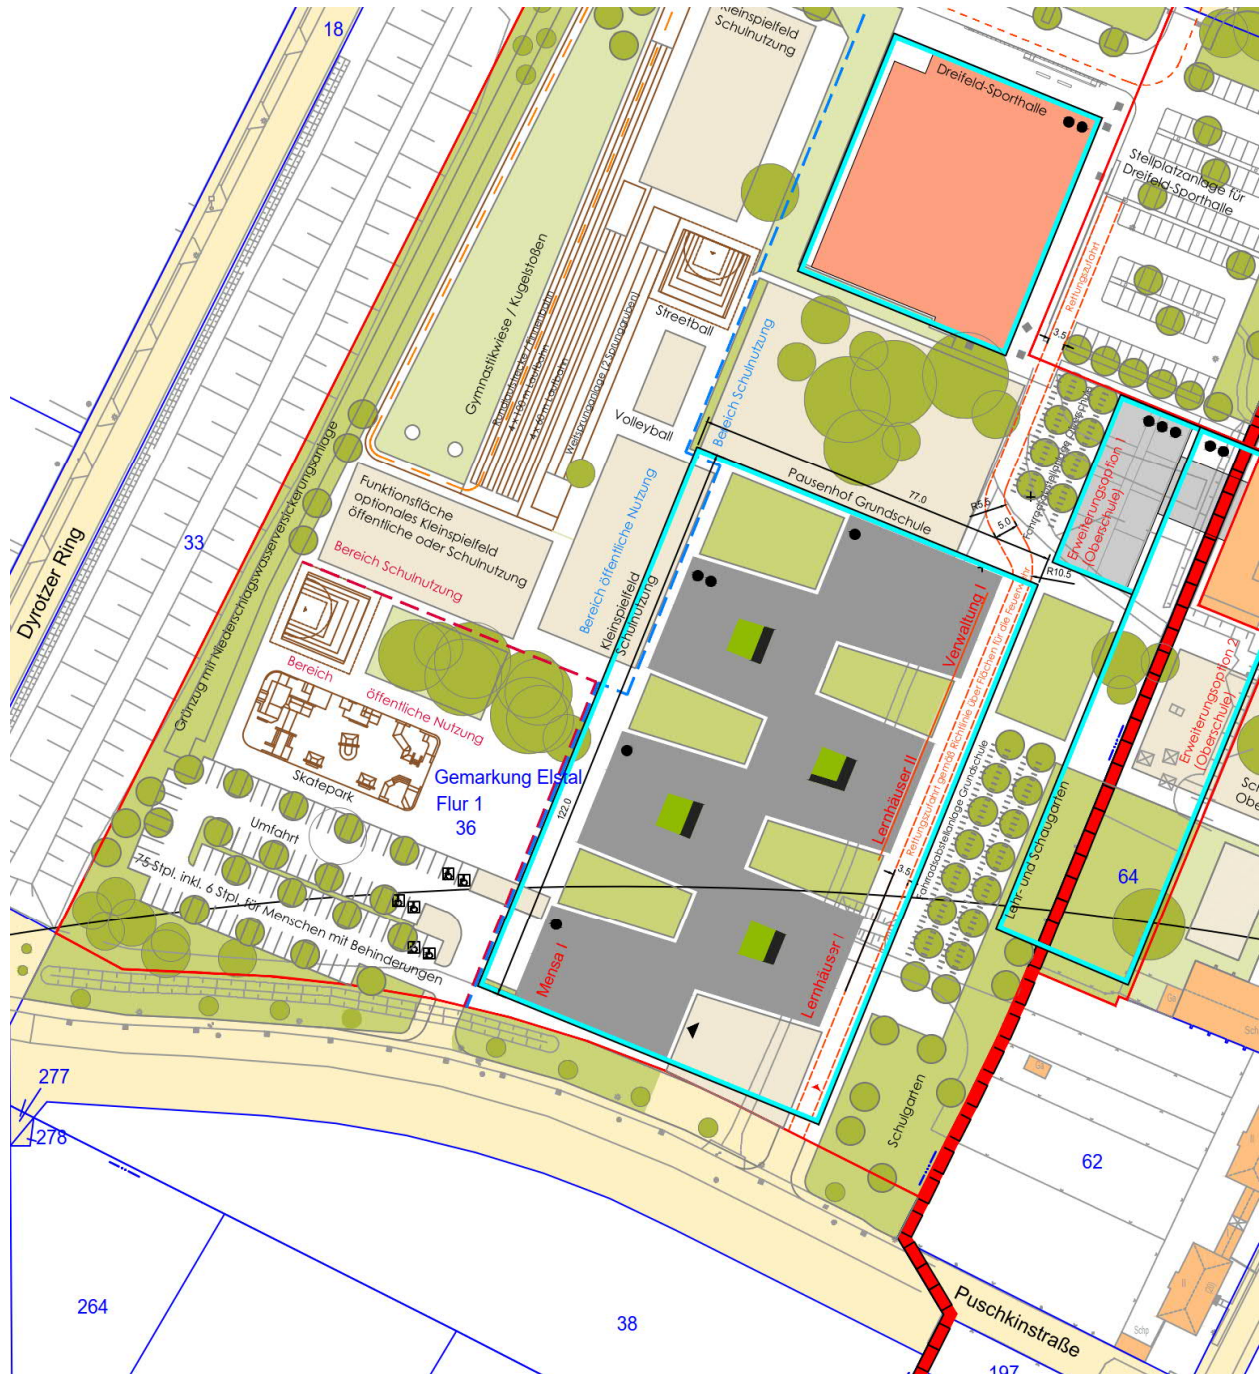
Lageplan mit maßgeblichen Gebäuden².
